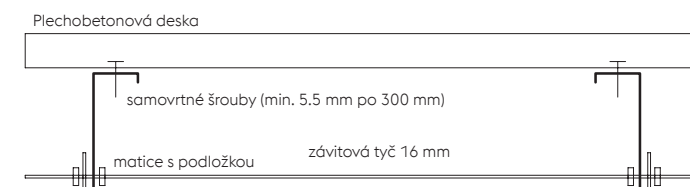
Provedení táhla v případě konstrukce těžkého provedení stropu.
